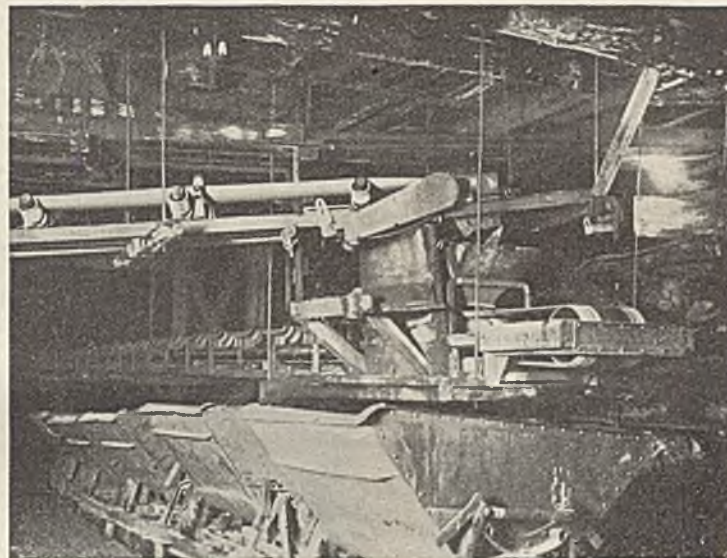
Ortsfestes Förderband mit Rampenband (Zubringerband). Bodenförderung unter der Betonförderung angeordnet.
